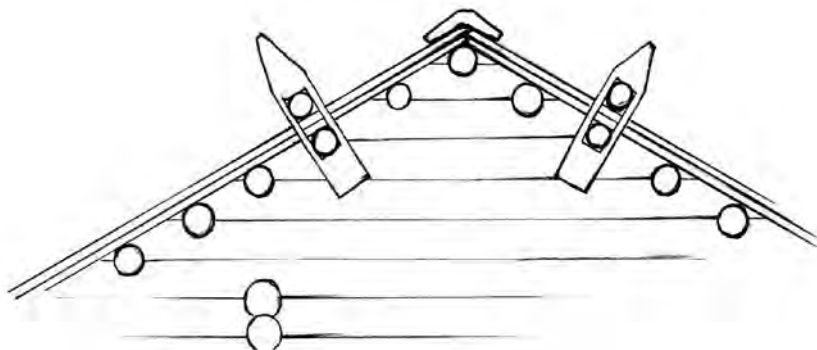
Конструкция безвозвевой самцово-слеговой кровли с гнетами, «чиби» и охлушем
